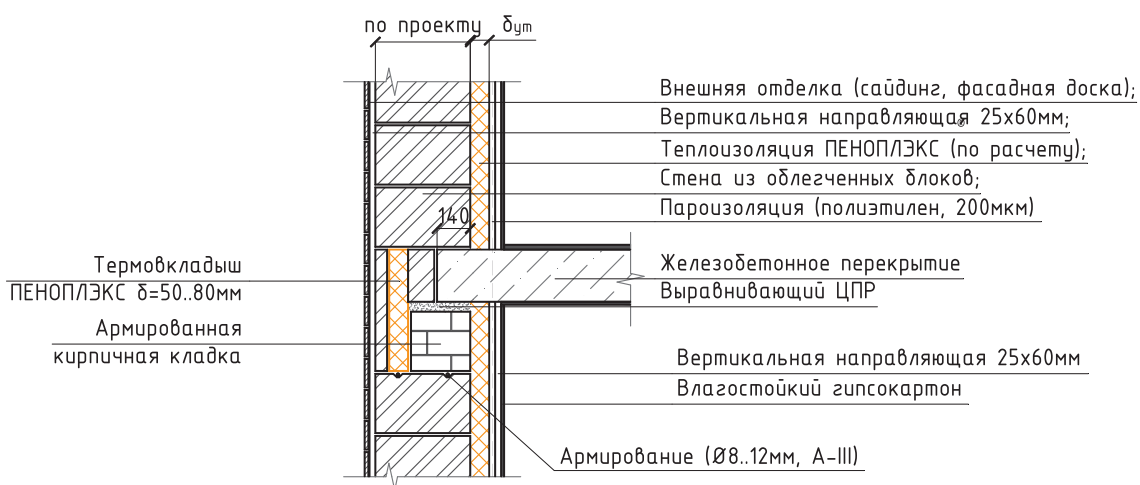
Схема сопряжения стены из облегченных блоков с железобетонным перекрытием (плиты ПЕНОПЛЭКС® изнутри).
